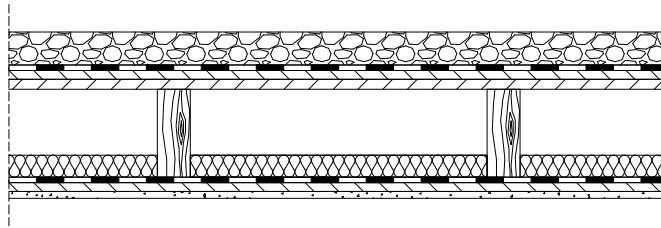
Typische Konstruktionen in der Altbausanierung: Holzständerwand mit Witterungsschutz
